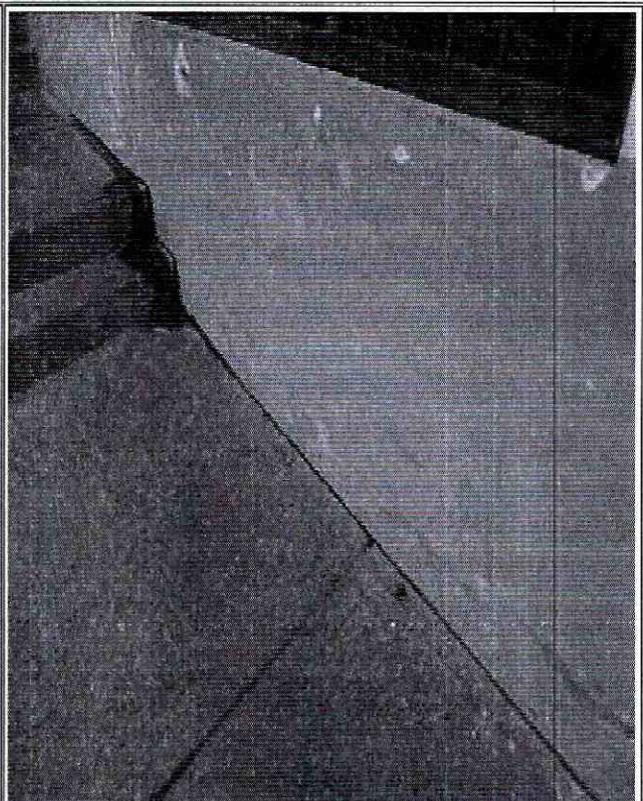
Humedades en muros divisorios y de cerramiento perimetral edificación Sede A Sección Primaria
